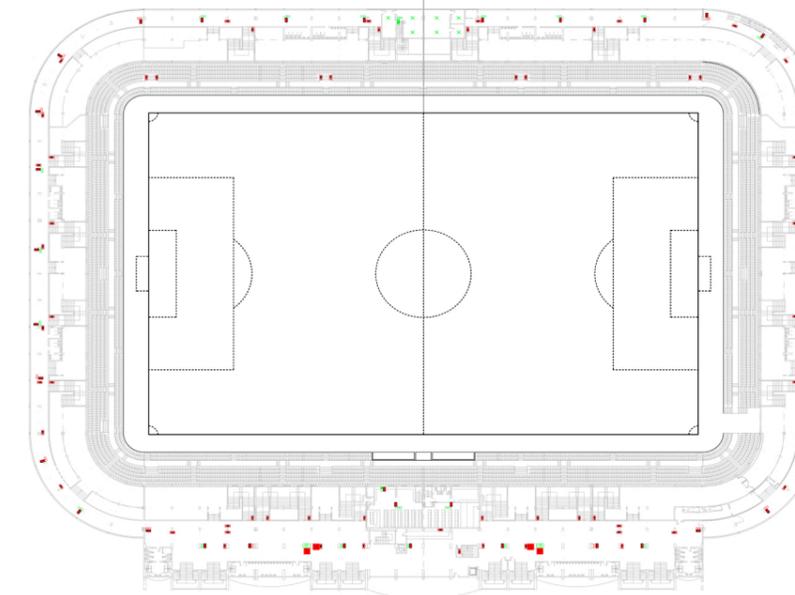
Planta general del estadio donde se aprecian los diferentes recorridos verticales y horizontales.
